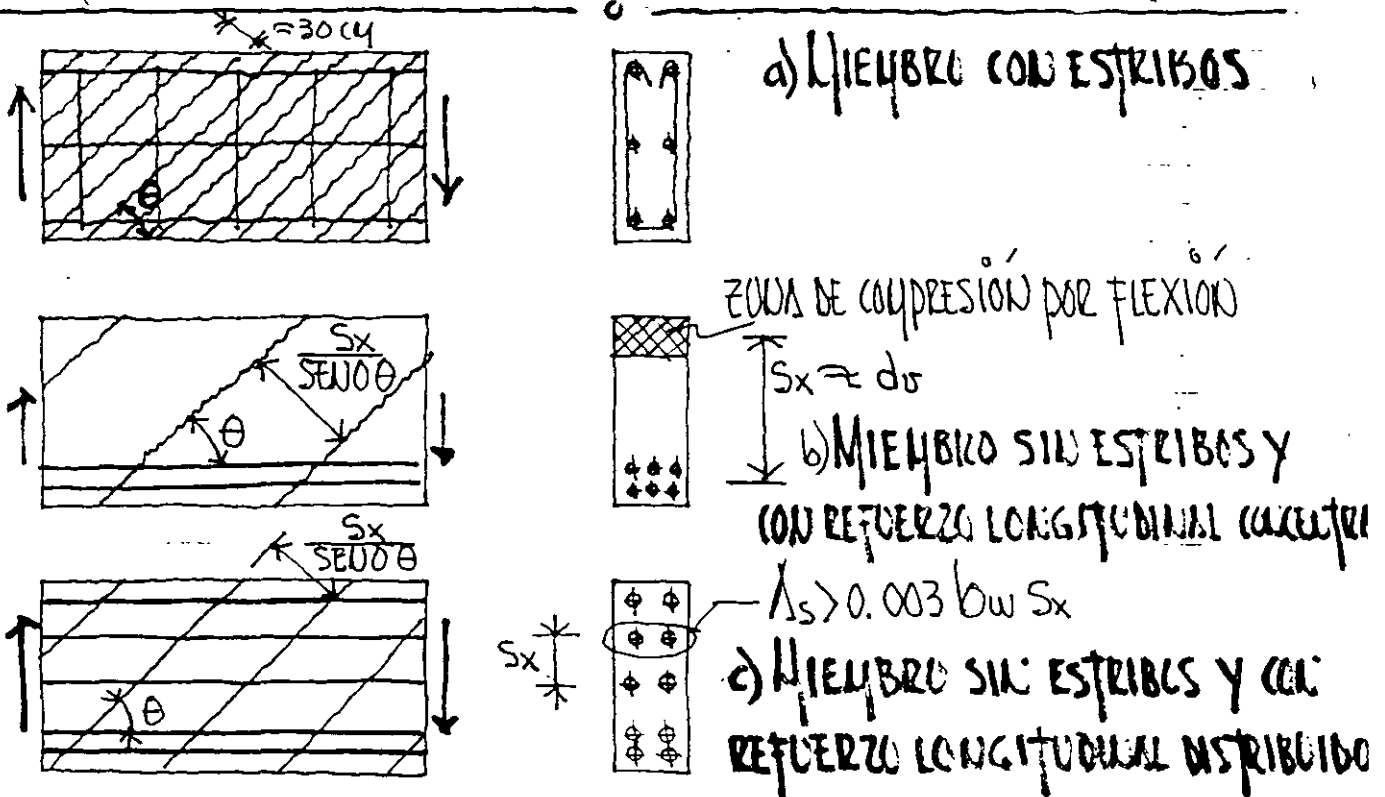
INFLUENCIA DEL REFUERZO SOBRE EL ESPACIAMIENTO DE GRIETAS
